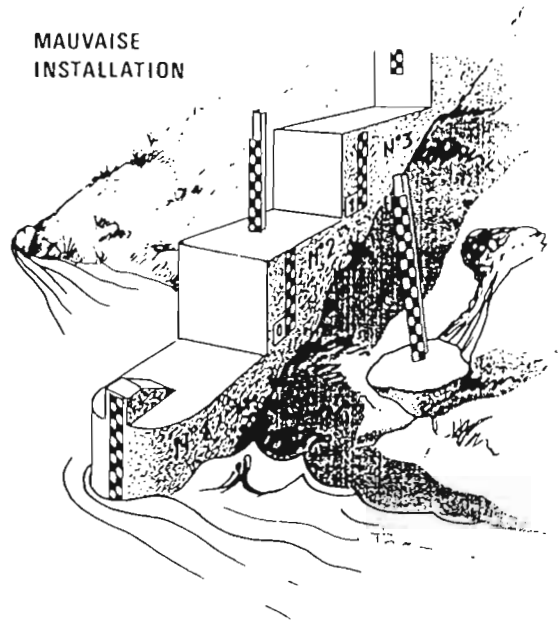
INSTALLATION DES ECHELLES LIMNIMETRIQUES (D'APRES J.THIEBAUX)
